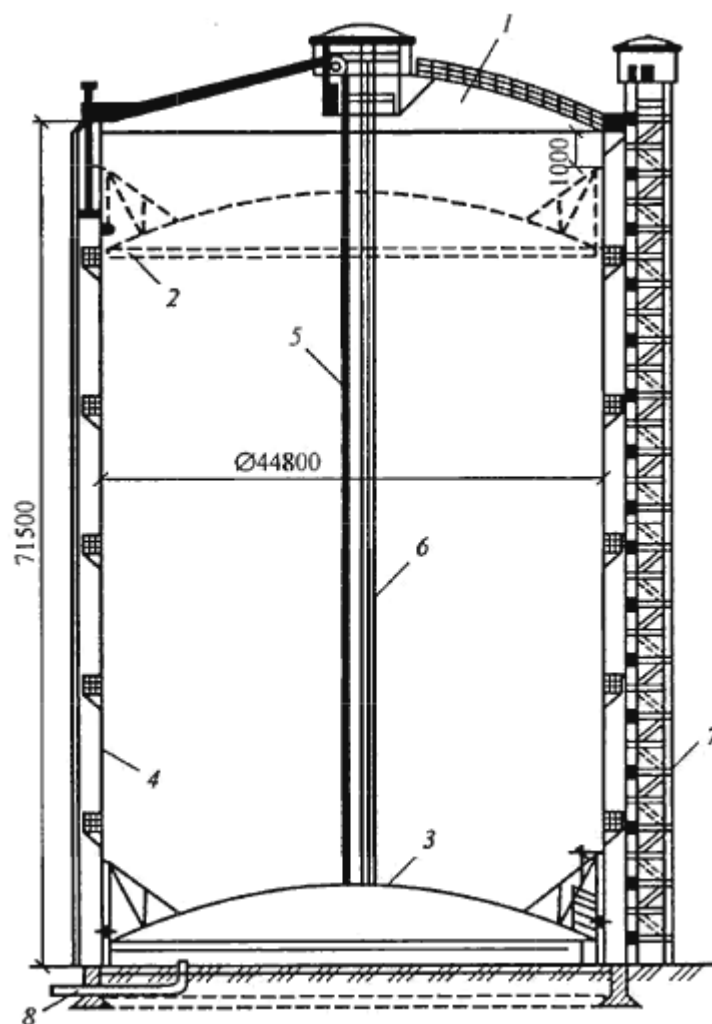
Схема сухого газгольдера объемом 100000 м³: 1 -площадка фонаря; 2 - шайба в верхнем положении; 3-шайба в нижнем положении; 4 - обшивка; 5-цспная лестница; 6-подъемная клеть; 7 - наружный подъёмник; 8 - подвод газа
